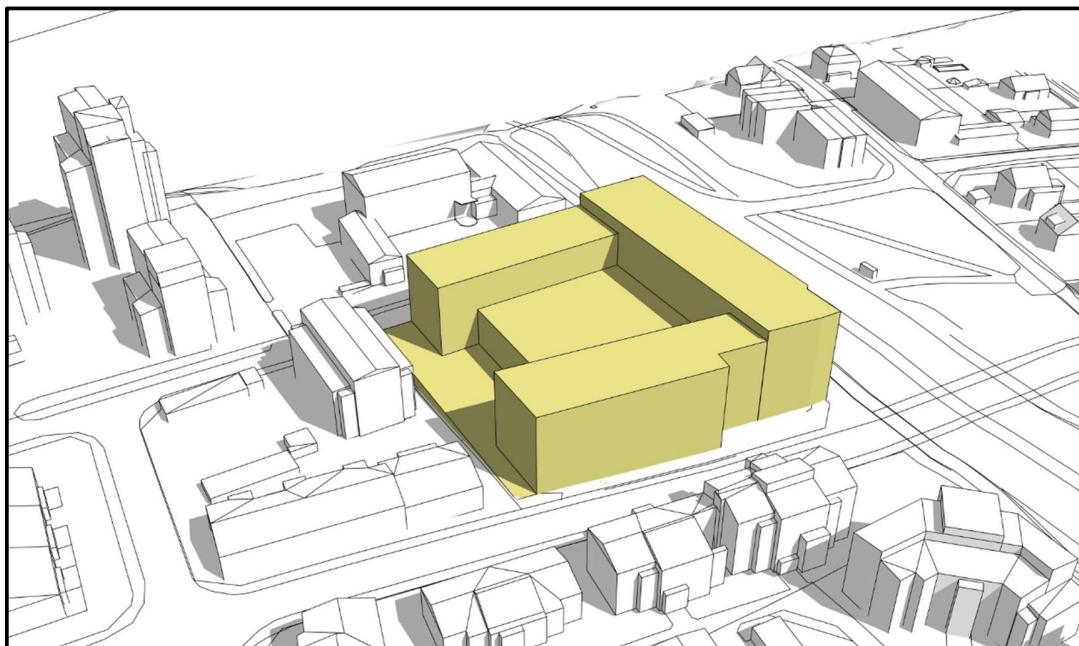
Exempel på utformning av infart till parkeringsanläggningens nedre däck från Skeppargatan. Bilden visar parkeringsanläggningen med högsta tillåtna nockhöjd enligt planen.
